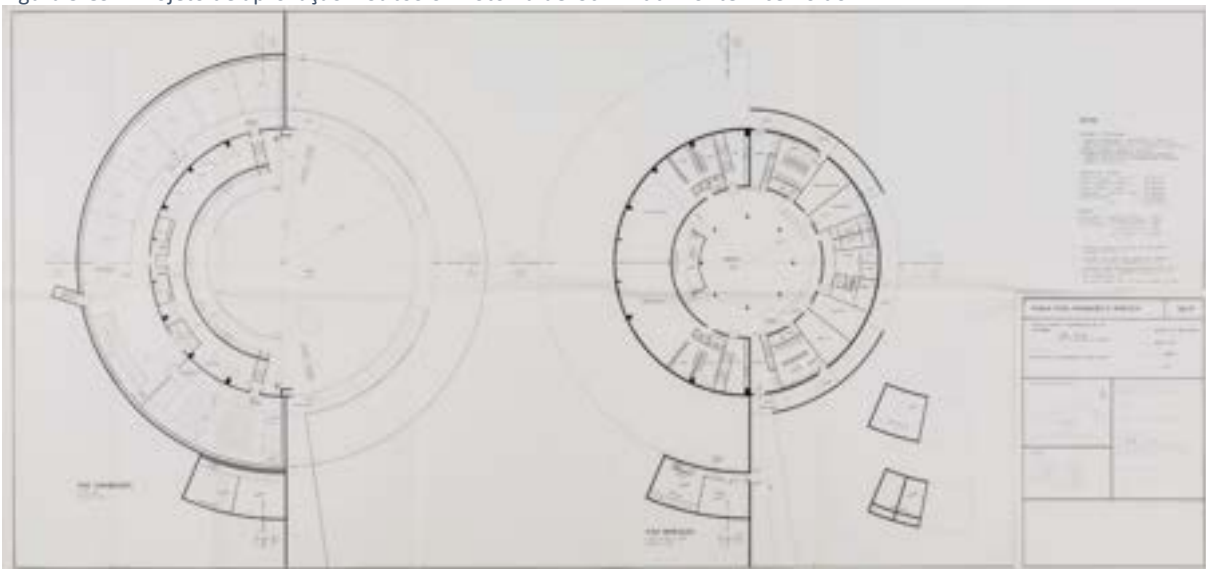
Projeto de aprovação – Térreo – foto Rafael Schimidt – fonte: Acervo do DEPAVE
